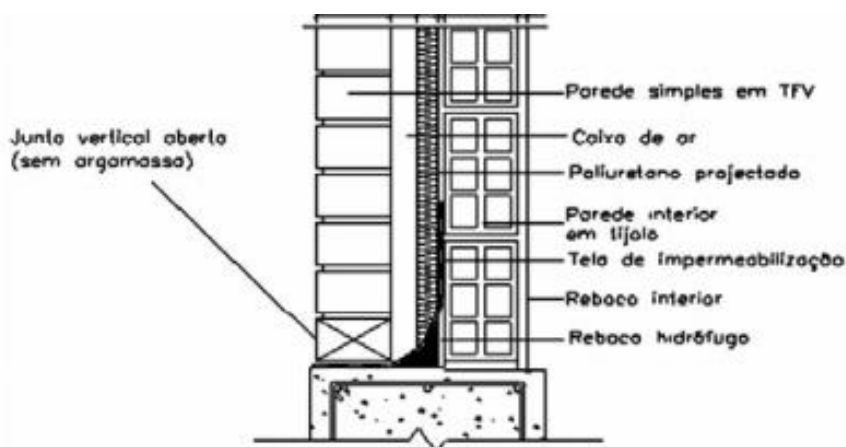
Tela de impermeabilização a acompanhar a meia cana em base de parede de tijolo face à vista [4]
